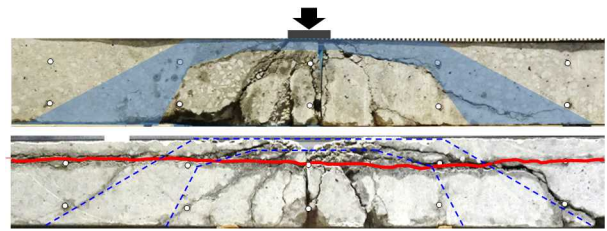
供試体 N のアーチ形成 (上図) と水平ひび割れのためアーチが形成できなかった供試体 F (下図)
